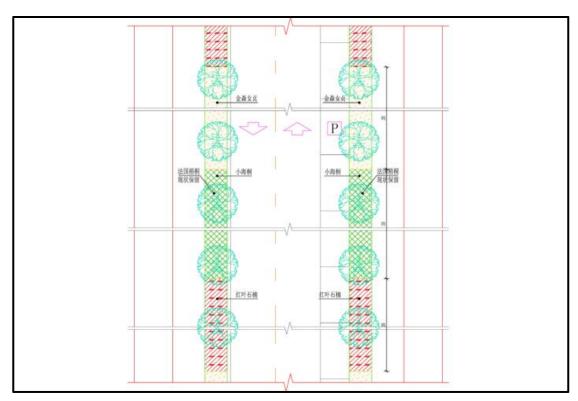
项目绿化标准段平面图 (青年路~青龙路)
